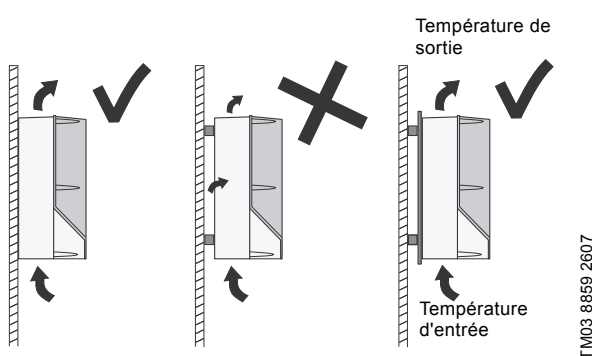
CUE fixé directement au mur ou fixé avec une plaque arrière.
